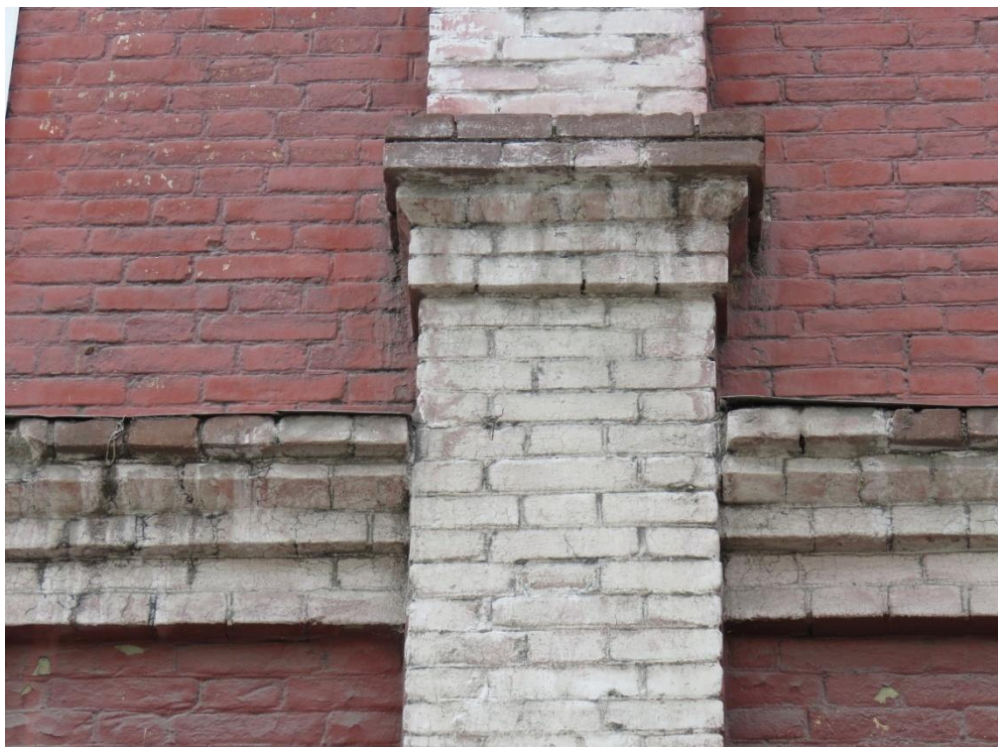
Фрагмент междуэтажного карниза северного фасада
